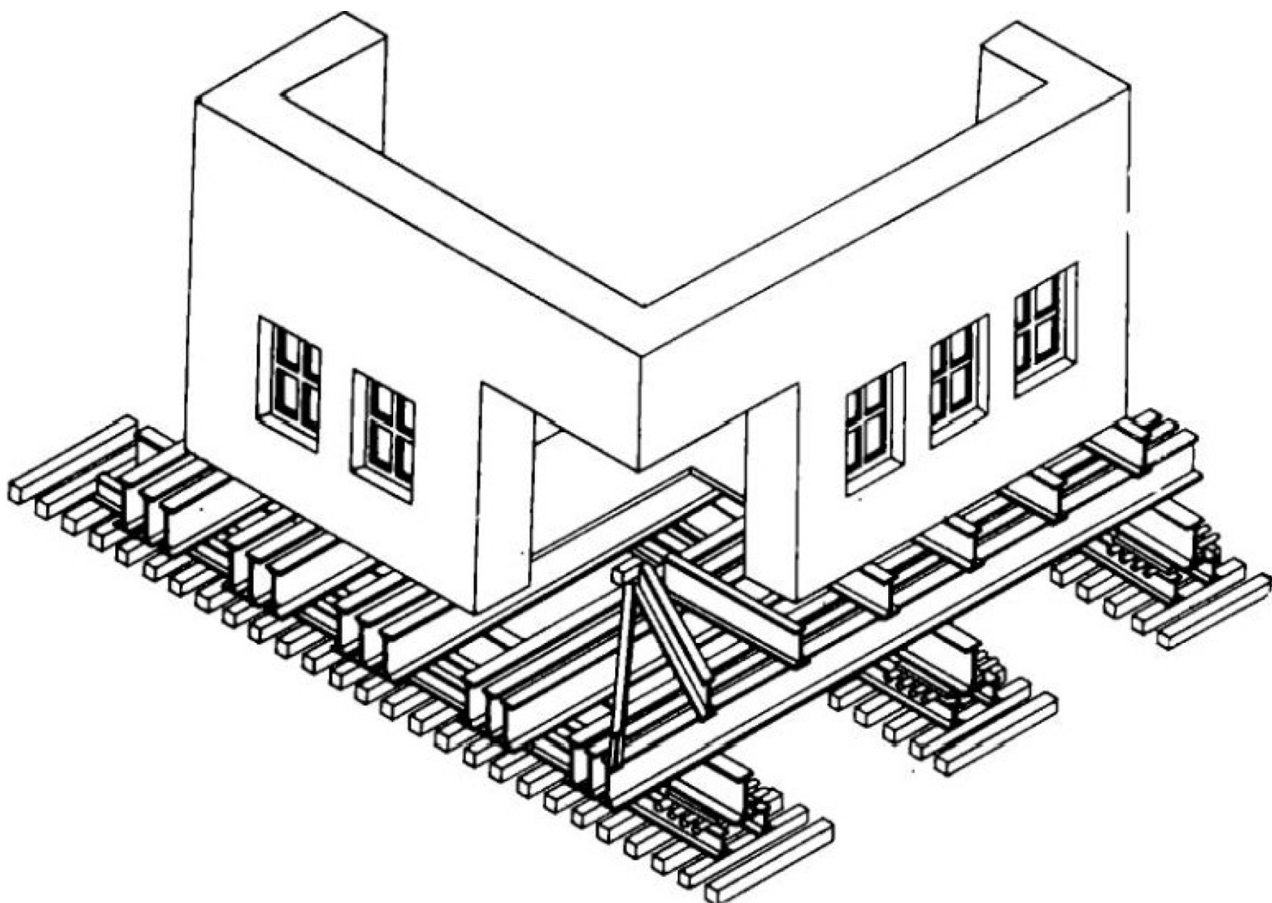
Схема конструкции для передвижения зданий в США [1]
